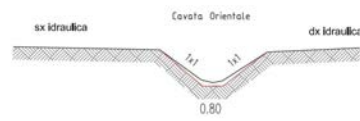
Sezione tipologica di progetto relativa al tratto 4. La linea nera indica la sezione rilevata nello stato attuale, quella rossa la sezione di progetto
